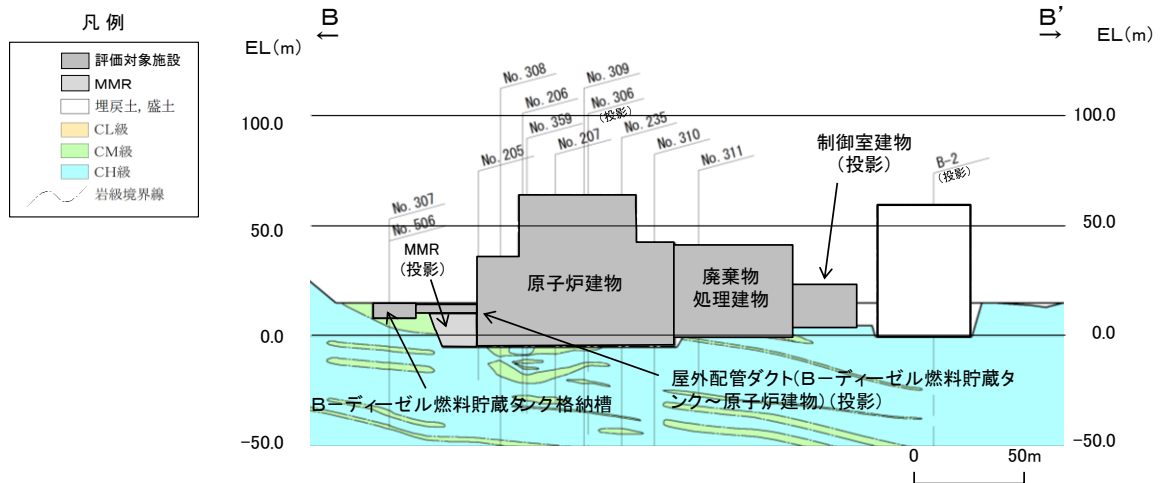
原子炉建物等の地質断面図 (B-B' 断面)
